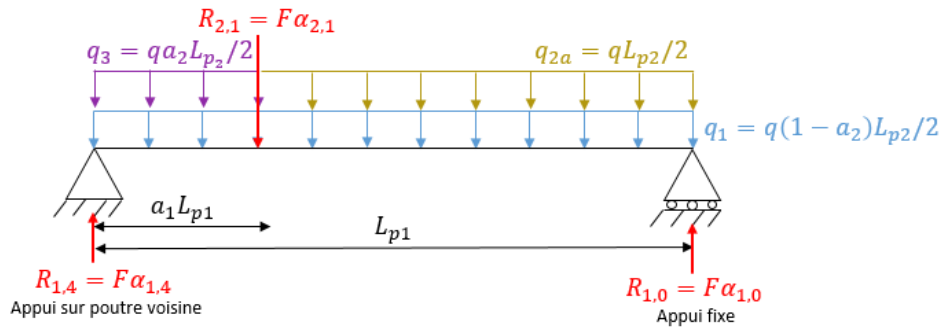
Schéma statique d'une poutre type 1 du plancher rectangulaire avec 1 sens de portée
